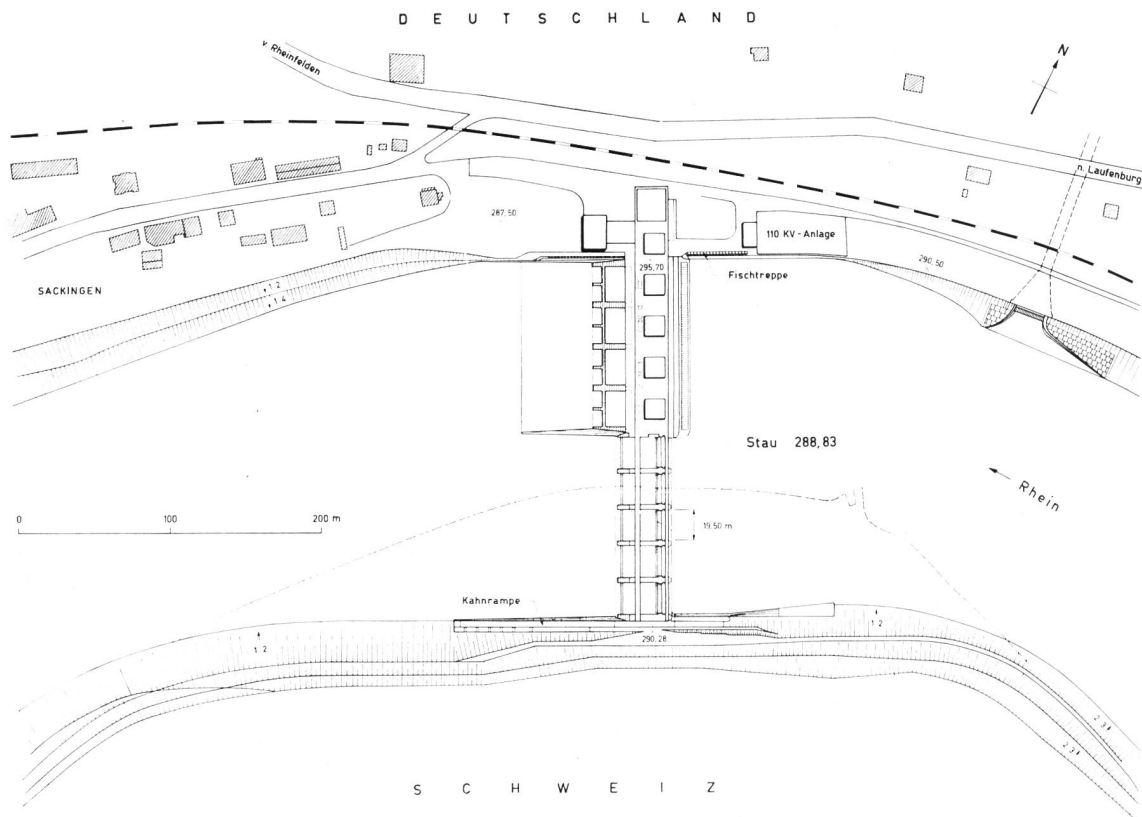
Grundriß von Maschinenhaus und Stauwehr Säckingern
